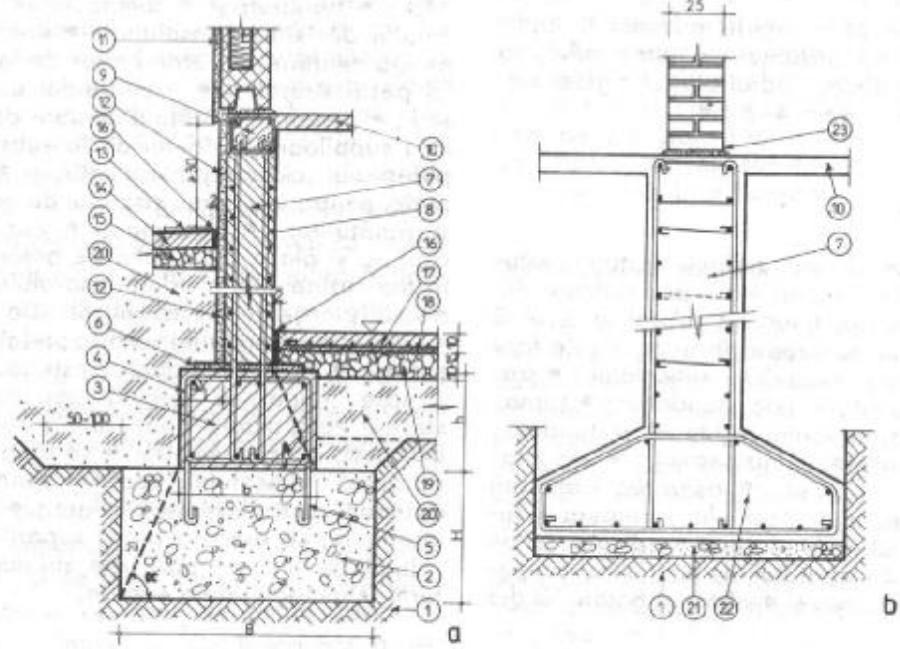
Fundații armate, sub zid exterior și sub zid interior, realizate din panouri mari prefabricate din beton armat :
